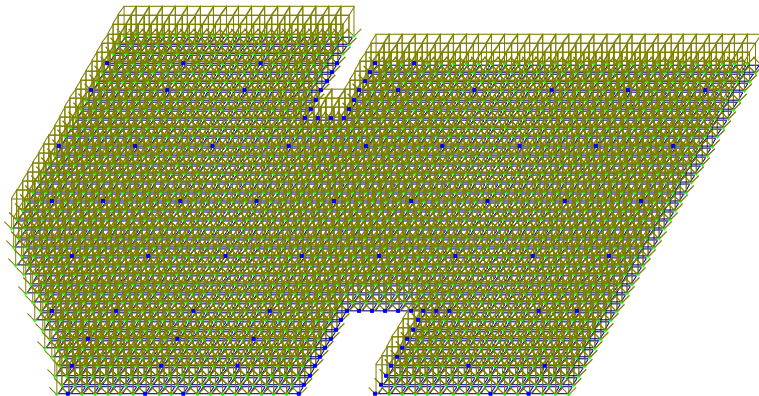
Розрахункова схема монолітної залізобетонної плити перекриття
